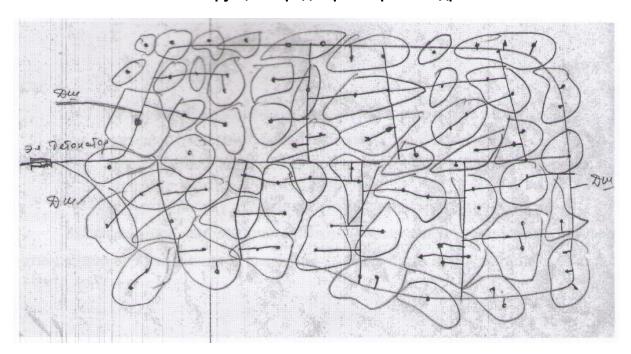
Схема соединения детонирующего шнура и конструкция заряда
